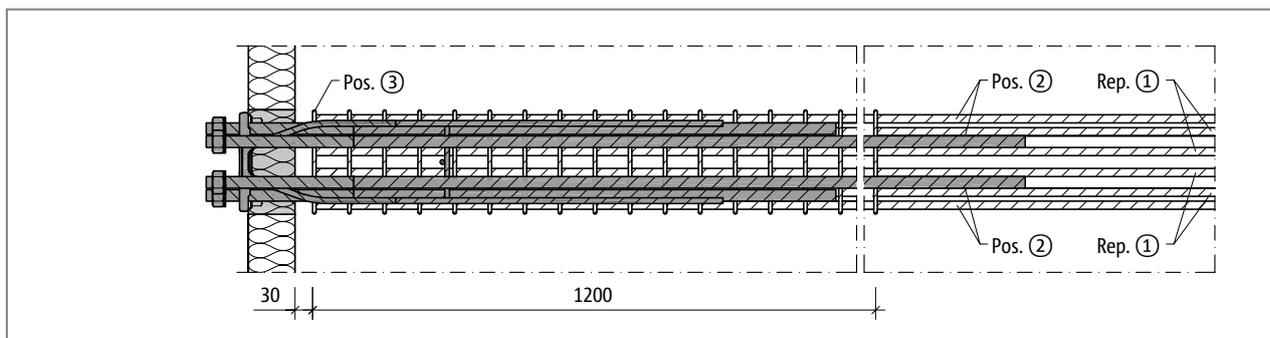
Schöck Isokorb® T type SK-MM2 : renforcement sur site, plan de base
